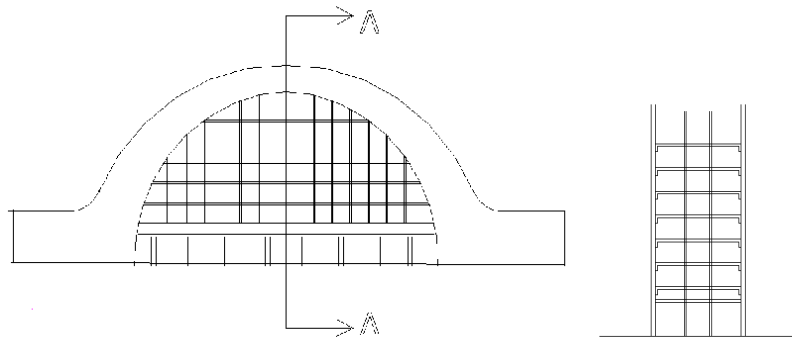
Le système architectural va de pair avec la solution de système de construction
